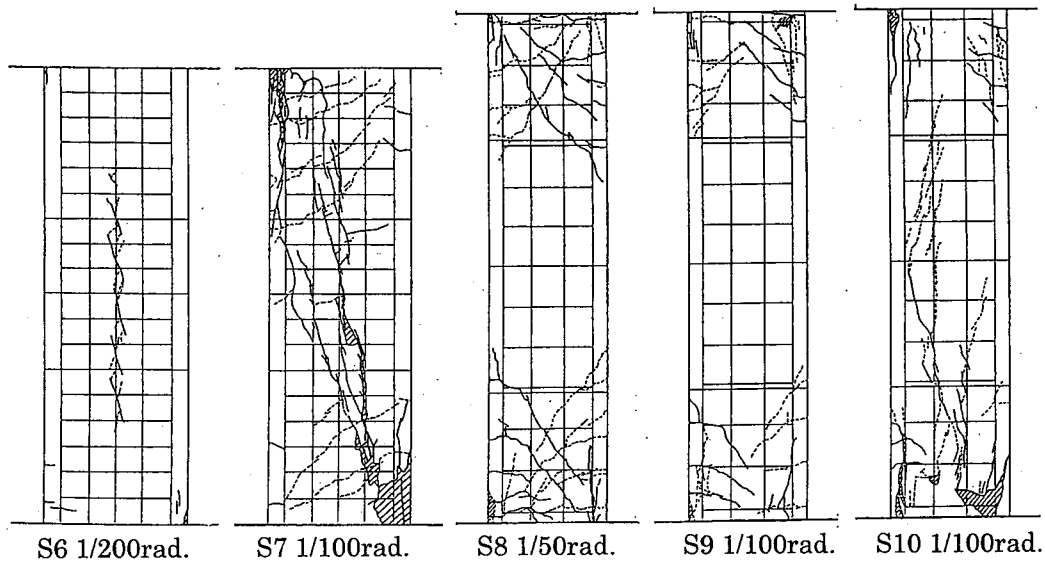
ひび割れ状況 (最大耐力時)
